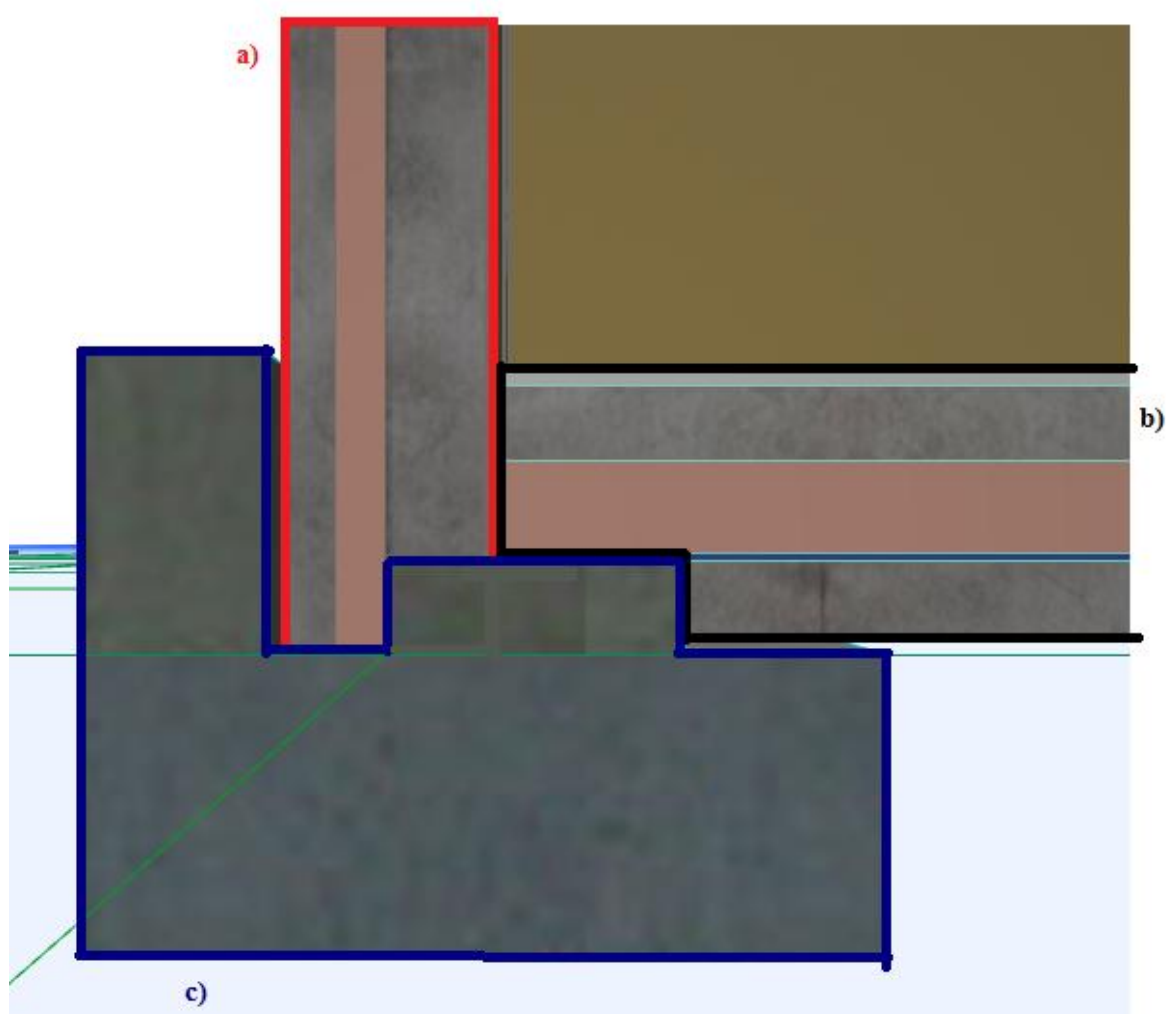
Pormenor de Ligação 3D entre: a) vigas de fundação; b) painéis de piso e c) Painéis Sandwich importados em IFC
